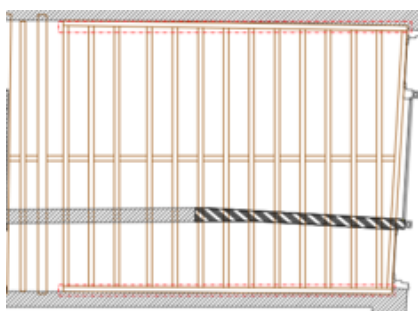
planta estrutural do pavimento PVC_3
